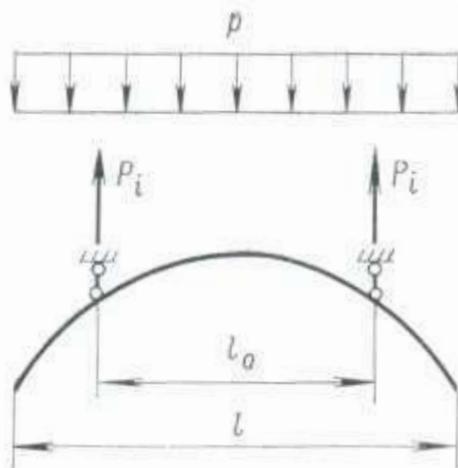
Расчетная схема выдвижной консольной предохранительной крепи
